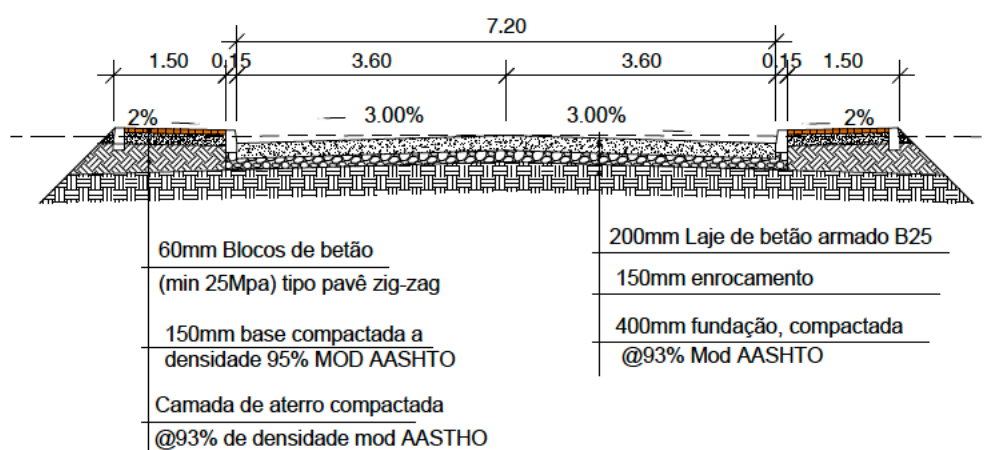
Perfil transversal tipo no cruzamento com a N1
